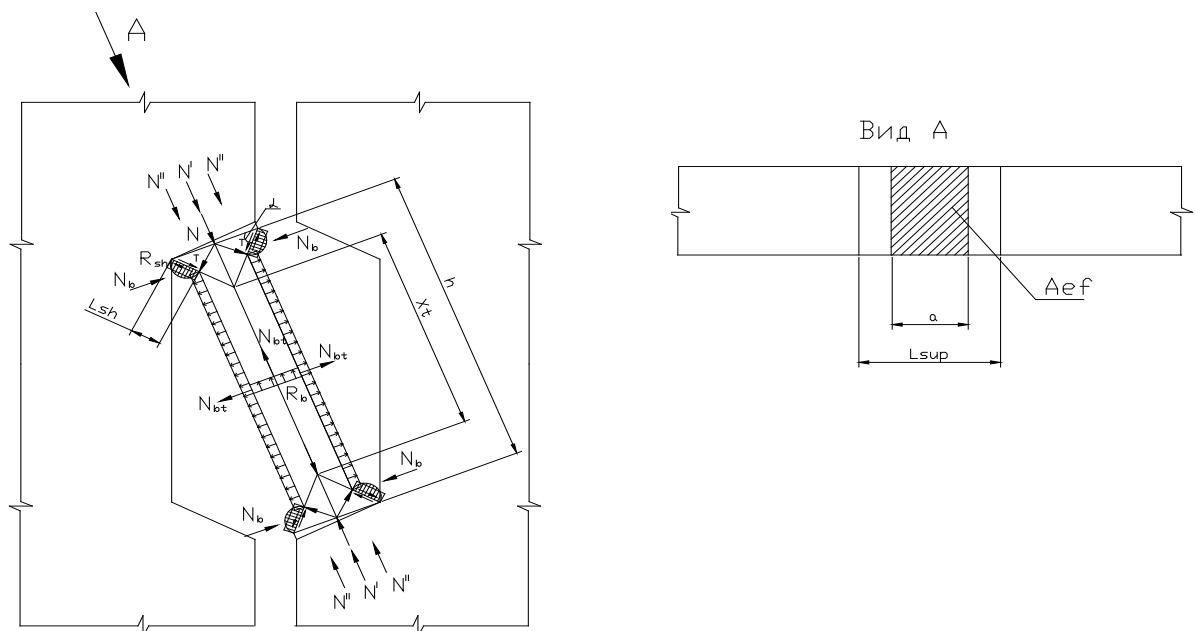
Розрахункова схема шпонкового з'єднання за [200]
